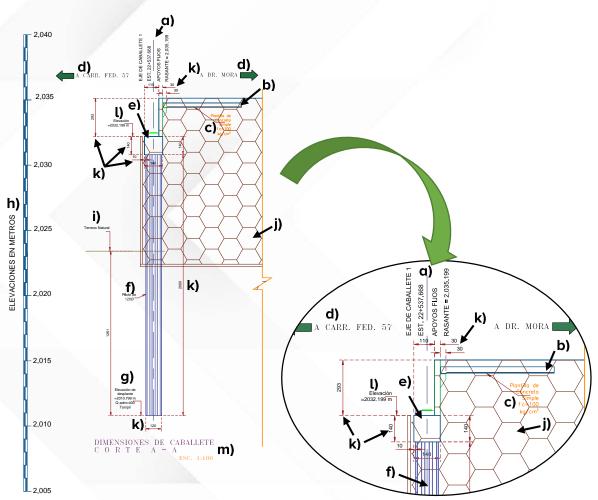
Ejemplo de dimensiones del caballete, corte A-A
